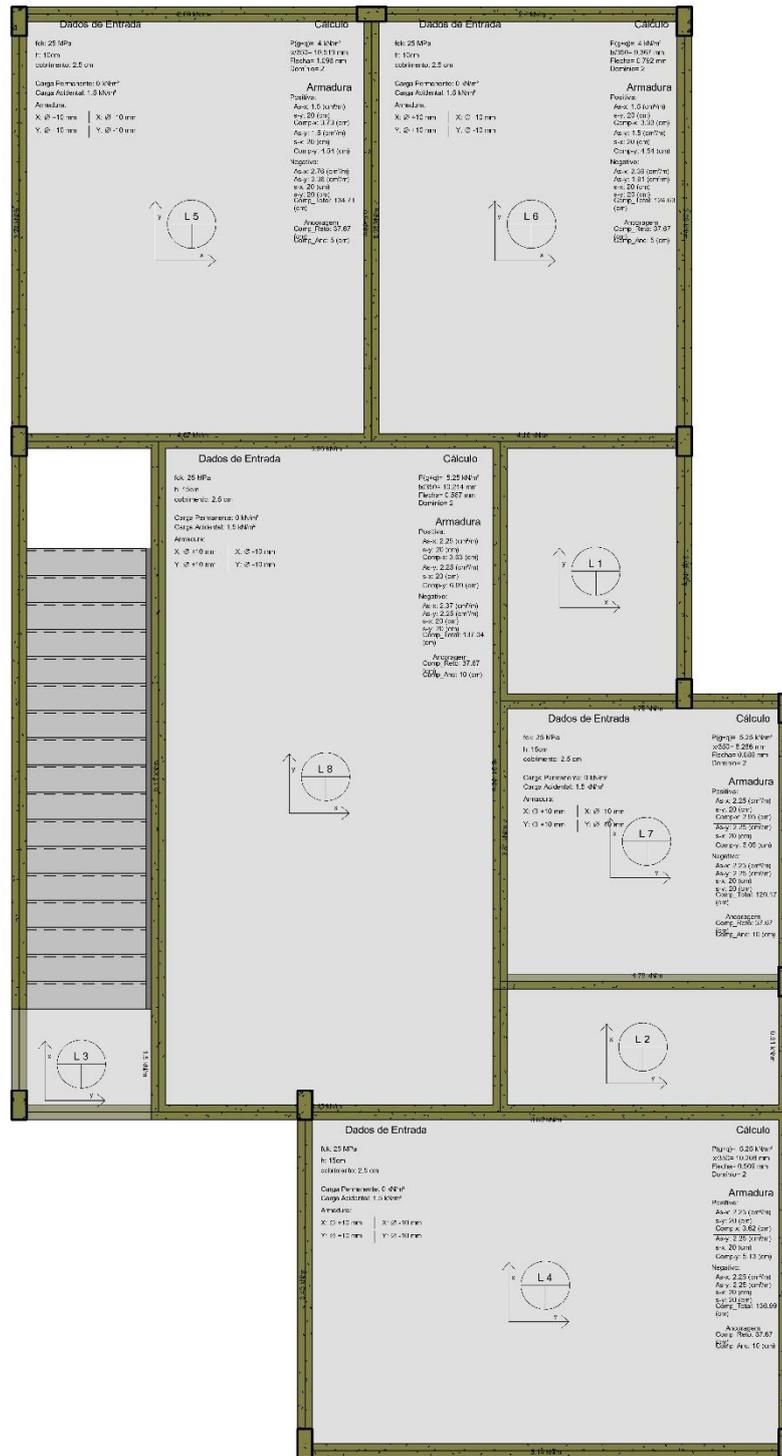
Todas as lajes do primeiro pavimento 01.
